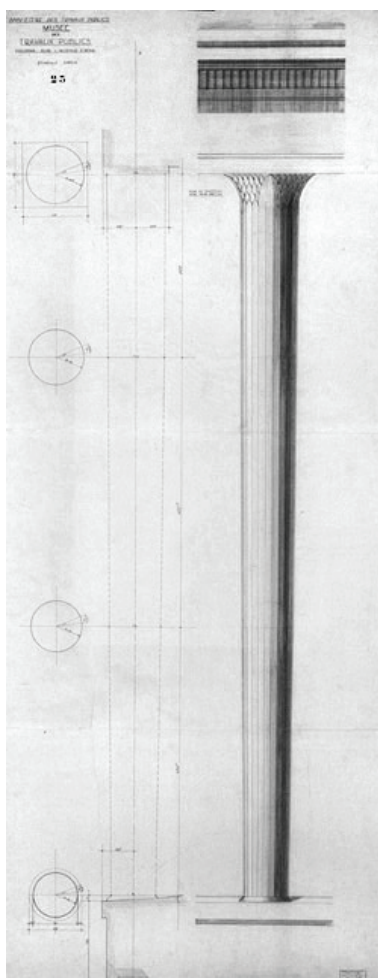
L'ordre du béton armé*: pormenorização do perfil e secções
